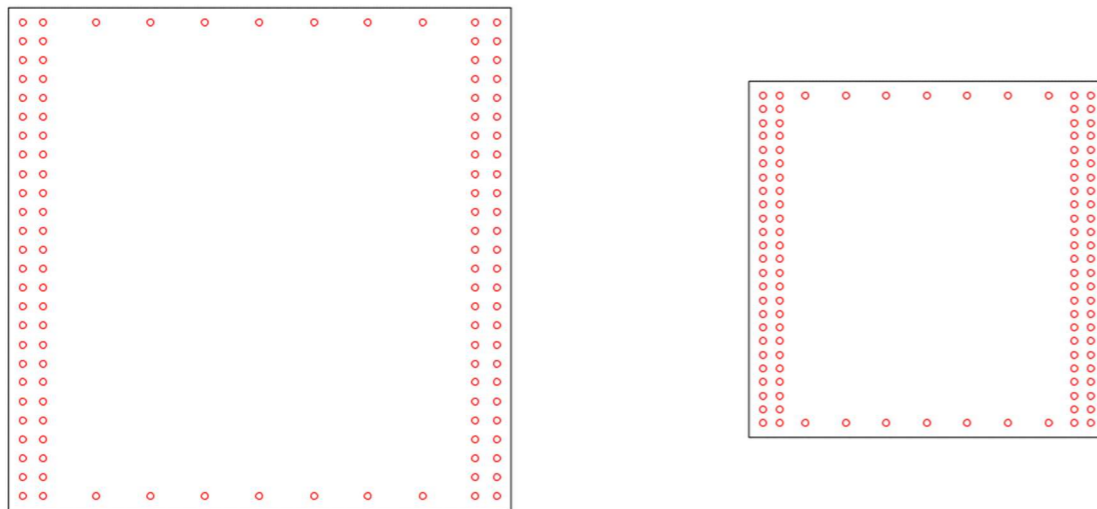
Secciones de base y cabeza de las pilas, con las armaduras longitudinales dispuestas (fuente: elaboración propia)
